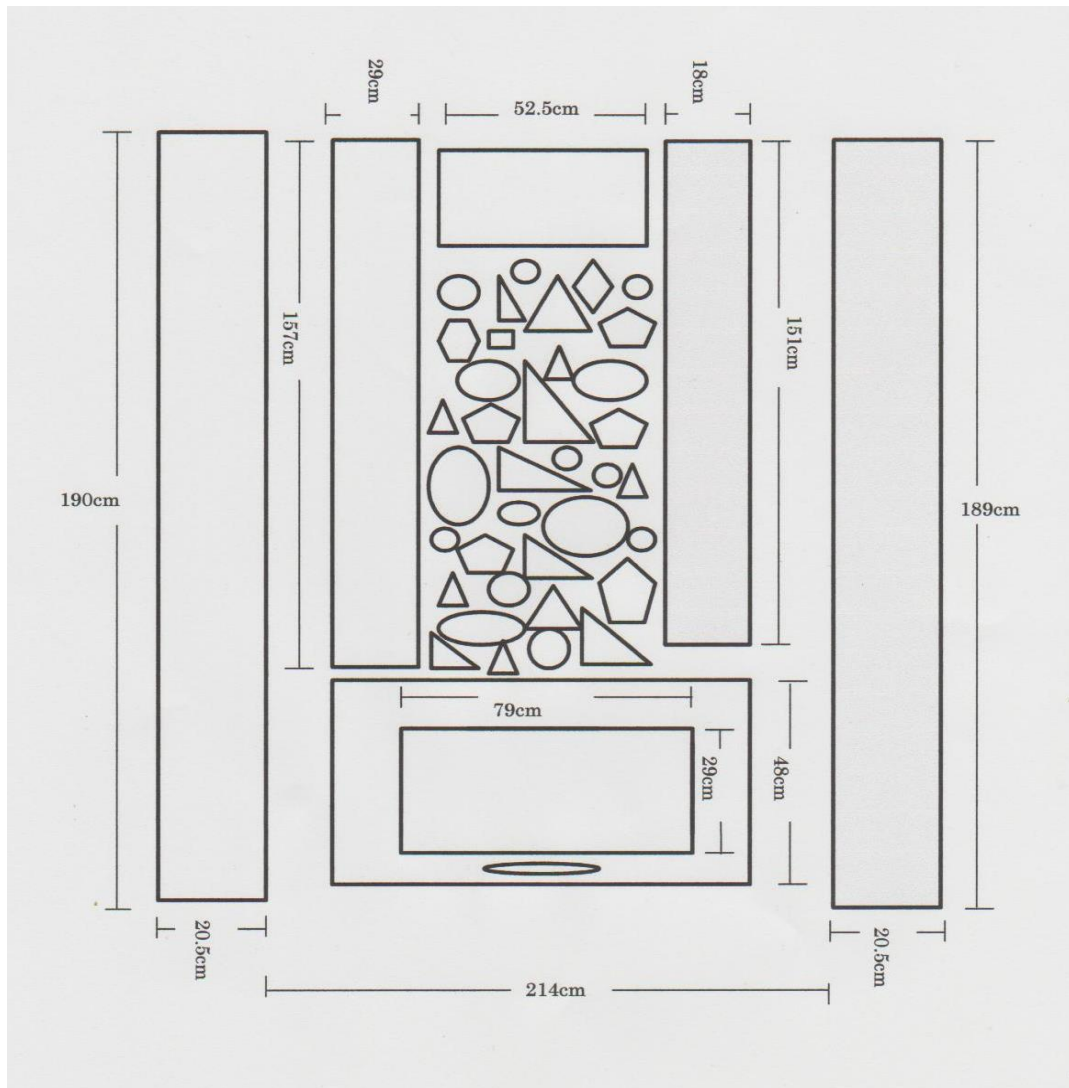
発掘後の趙可欽の墓の平面図 (筆者作成)
